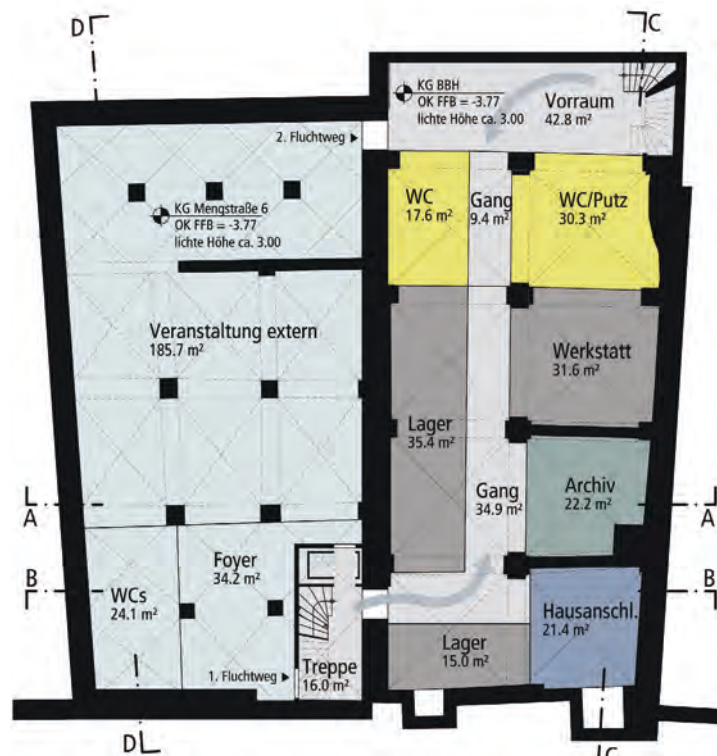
Variante 3, Grundriss Keller
